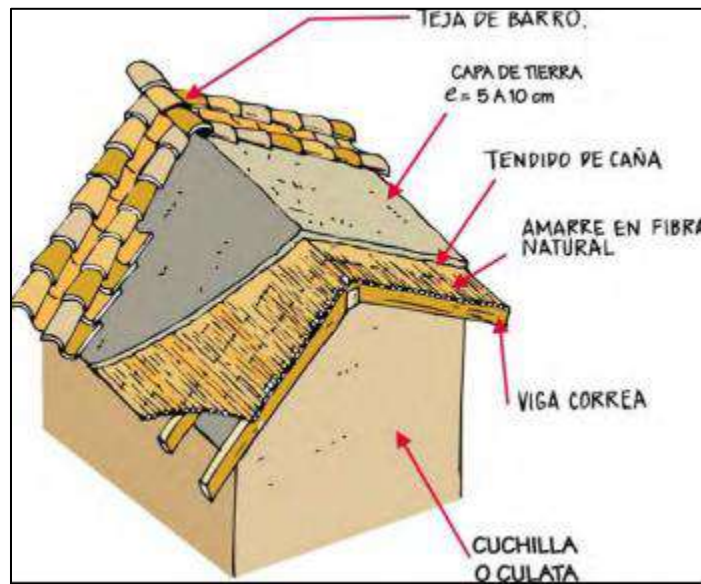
ILUSTRACION SISTEMA ESTRUCTURAL Y CONSTRUCTIVO
